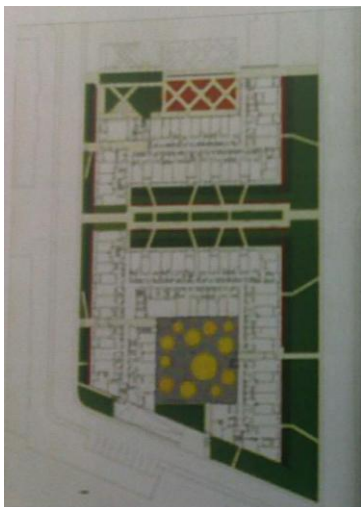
Planta térrea do conjunto habitacional do atelier Laverdière Architects em Saia (2000), Montreal.
